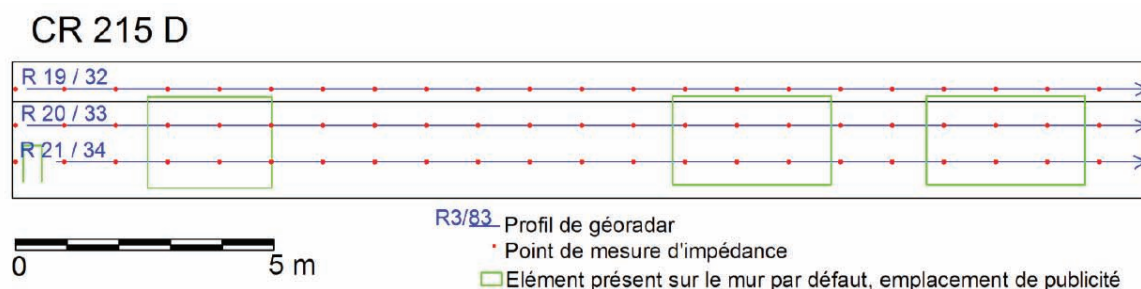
Plan d'implantation de profils géoradar sur un panneau d'essai
